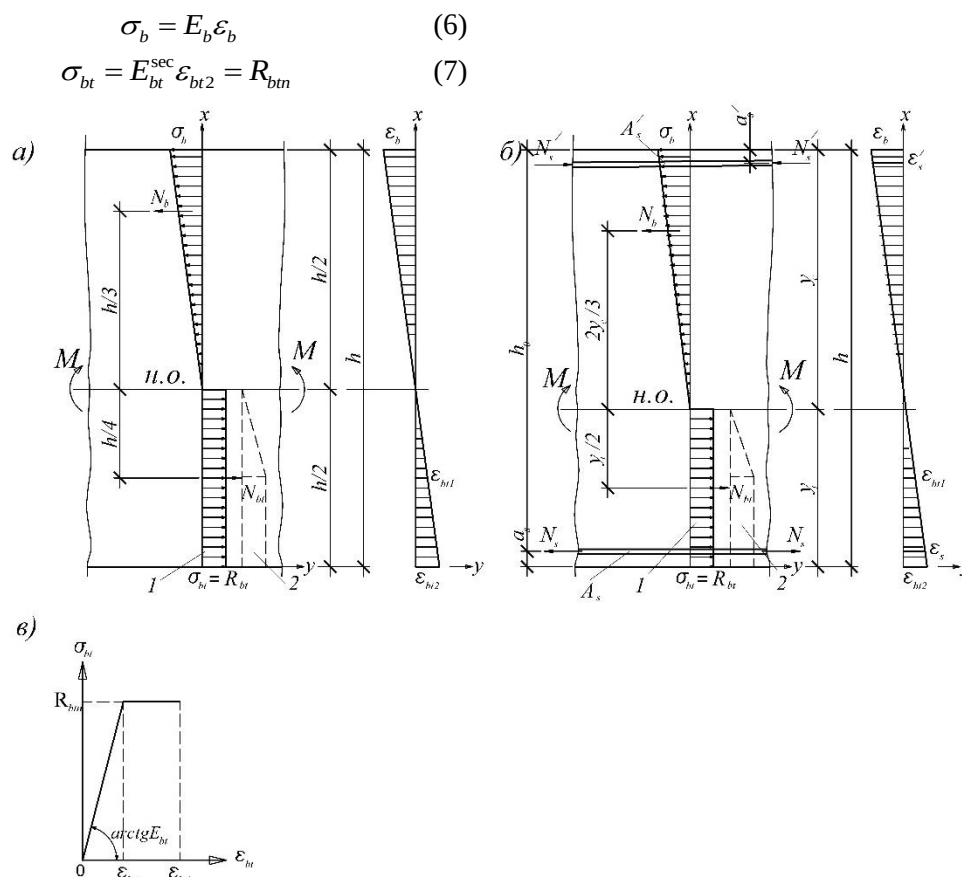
Схемы усилий, напряжений и деформаций бетонного сечения (а) и железобетонного (б); диаграмма деформирования бетона в растянутой зоне (в): 1 – эпюра нормальных напряжений в растянутой зоне бетона по СНиП 2.03.01-84*; 2 – то же по СП 63.13330.2012
